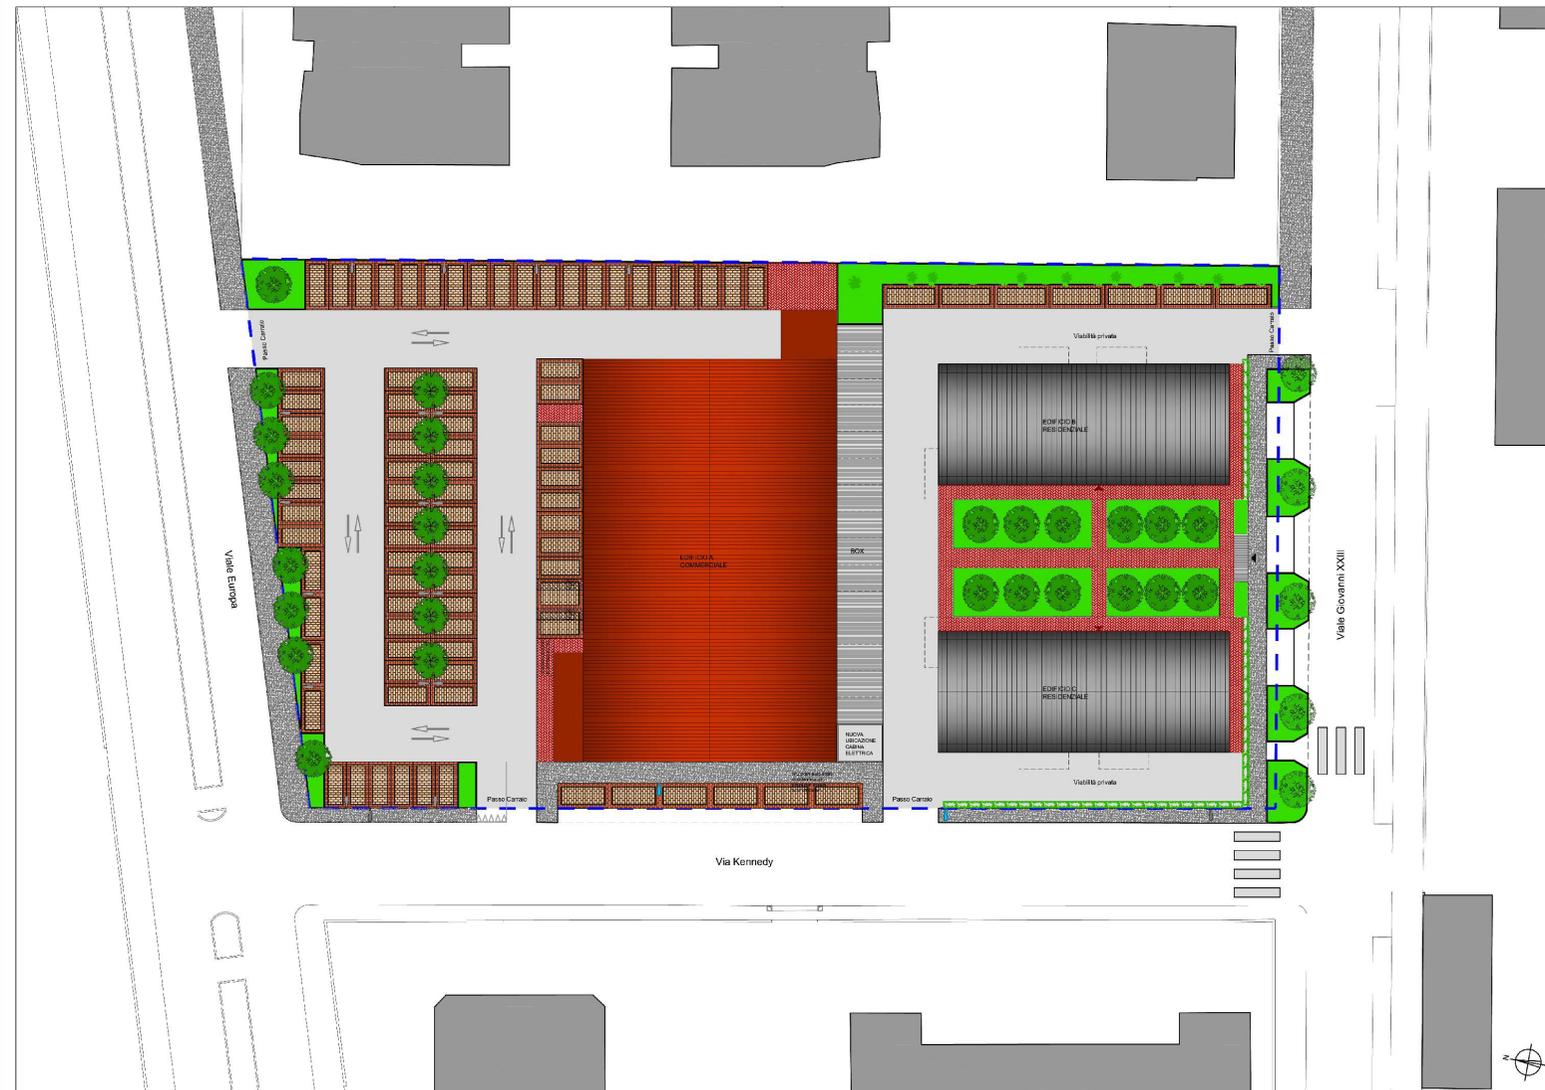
Stralcio Tav. PR 05 – Planimetria Generale
